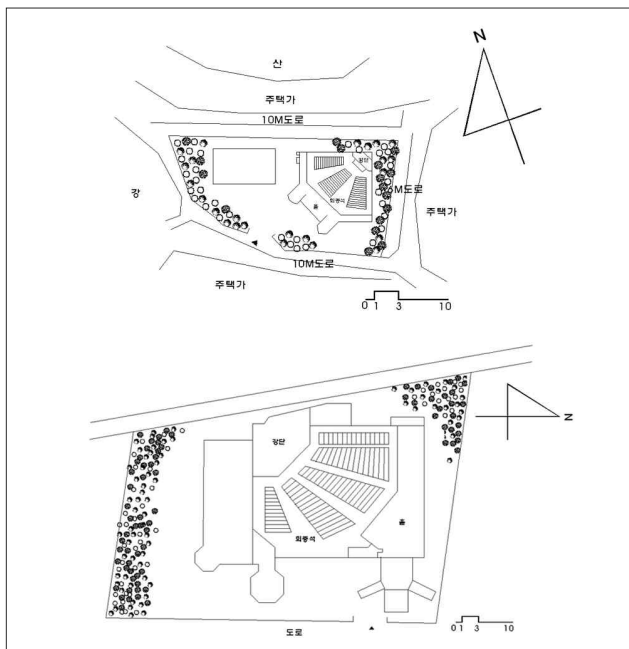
D2(상) D3(하)교회 배치도 및 평면도
